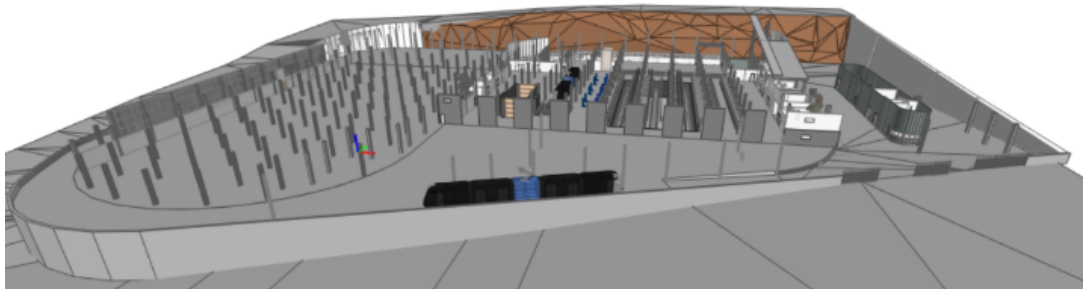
Planta Baja en aplicación BIM Vision Elaboración Propia.
